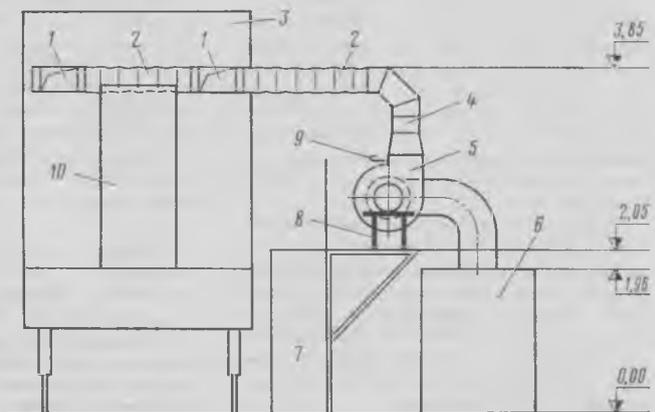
Схема установки вентиляционной системы в депо: 1 — насадка; 2 — гибкий воздуховод; 3 — тепловоз; 4 — воздуховод; 5 — центробежный вентилятор; 6 — кондиционер; 7 — лестничная площадка; 8 — подставка под вентилятор; 9 — шибер вентилятора; 10 — дизель тепловоза
